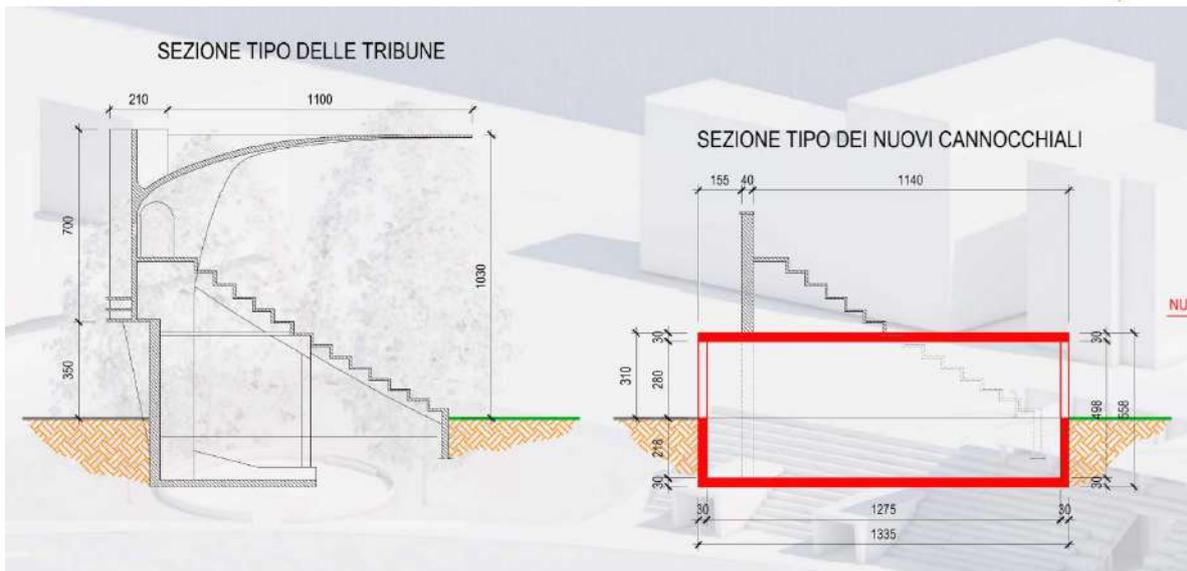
Sezione di progetto Tribune – Arch. Roberto Rosset
